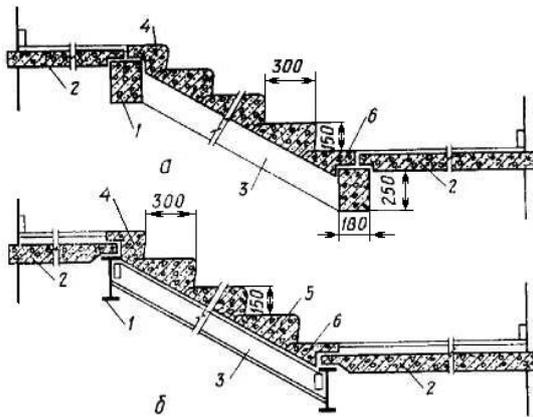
Мелкоэлементные двухмаршевые лестницы из наборных ступеней: а – по железобетонным косоурам; б – по металлическим косоурам; 1 – подкосоурная балка; 2 – площадочная плита; 3 – косоур; 4 – верхняя фризная ступень; 5 – рядовая ступень; 6 – нижняя фризная ступень.
